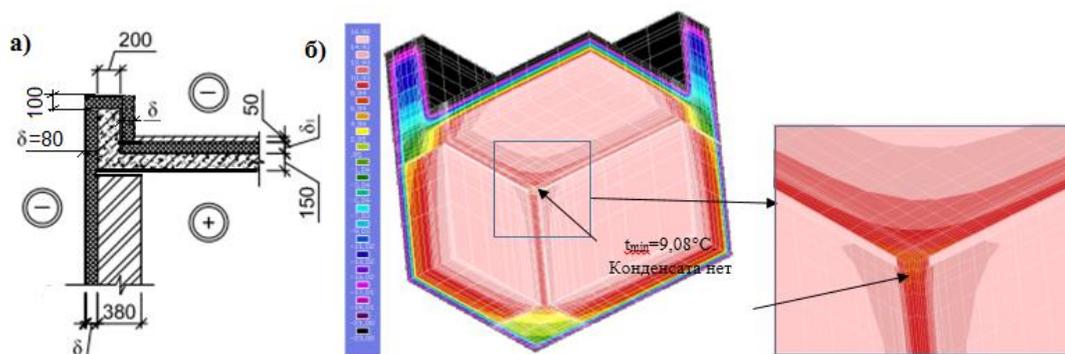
Узел примыкания наружной стены к чердачному перекрытию (разработанное решение): а – конструкция узла; б – температурное поле узла
